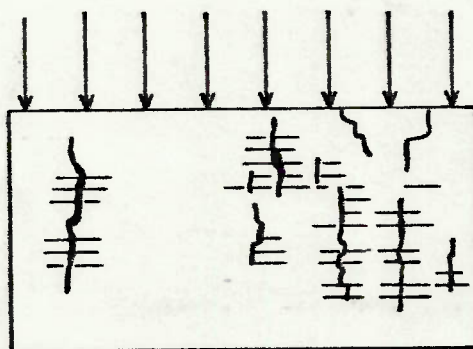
Fissuração típica da alvenaria causada por sobrecarga vertical
